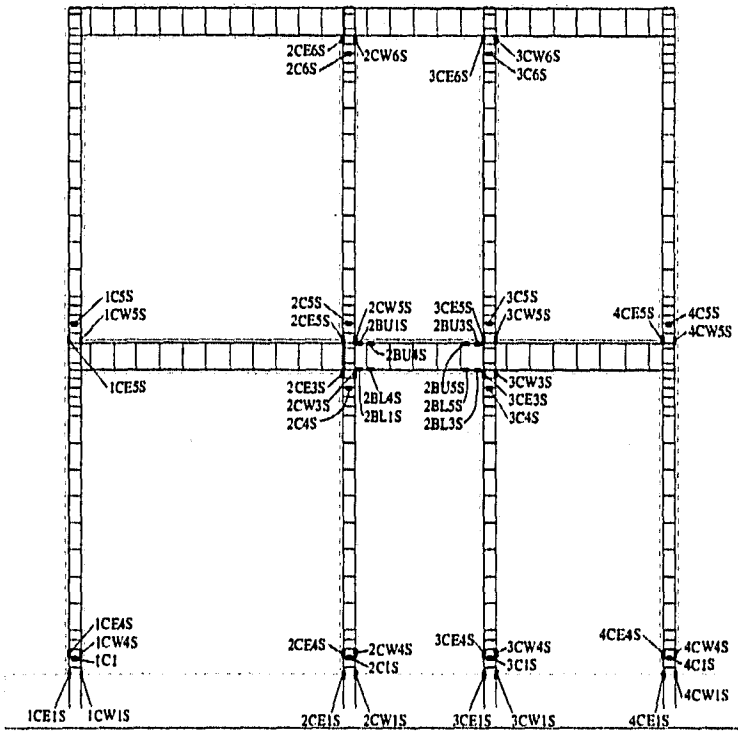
Ubicación de Deformímetros en el Acero de Refuerzo (Muro Sur)
